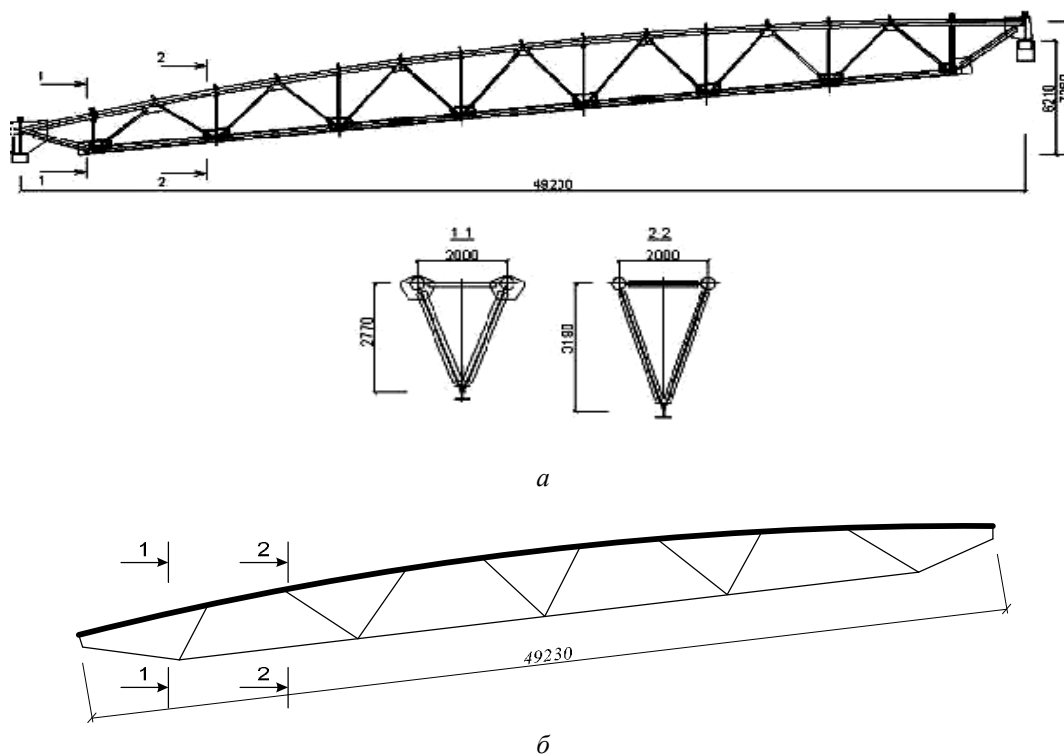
Схеми ферм: а – кроквяна ферма у вигляді просторової конструкції з верхнім поясом із двох труб прольотом 50 м; б – раціональна комбінована ферма прольотом 50 м у вигляді просторової конструкції з верхнім поясом із двох труб
